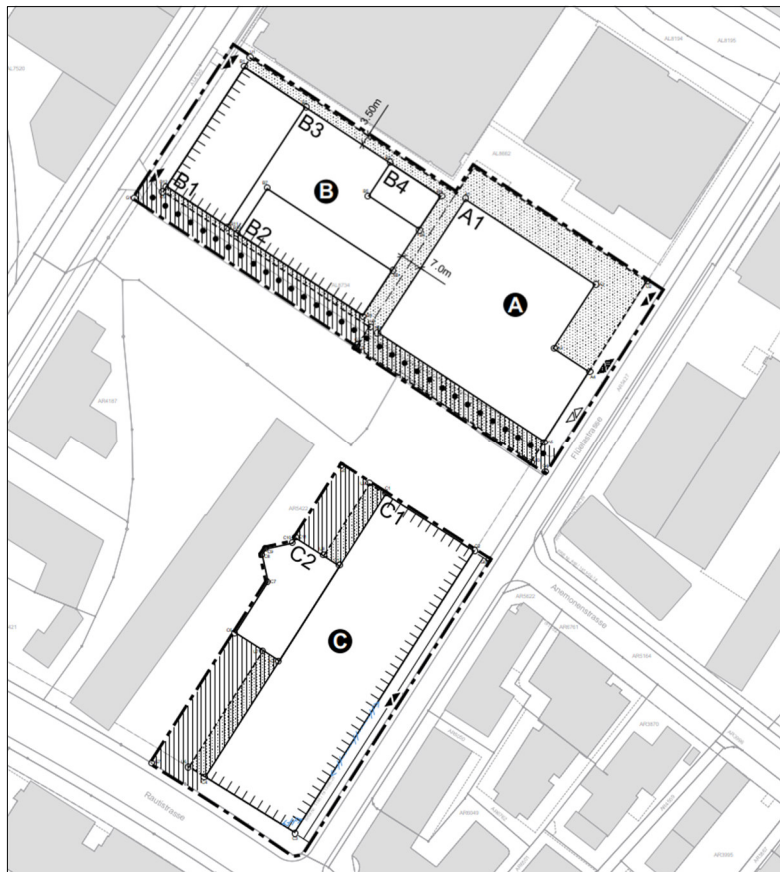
Situationsplan des Perimeters mit den Teilgebietbezeichnungen
